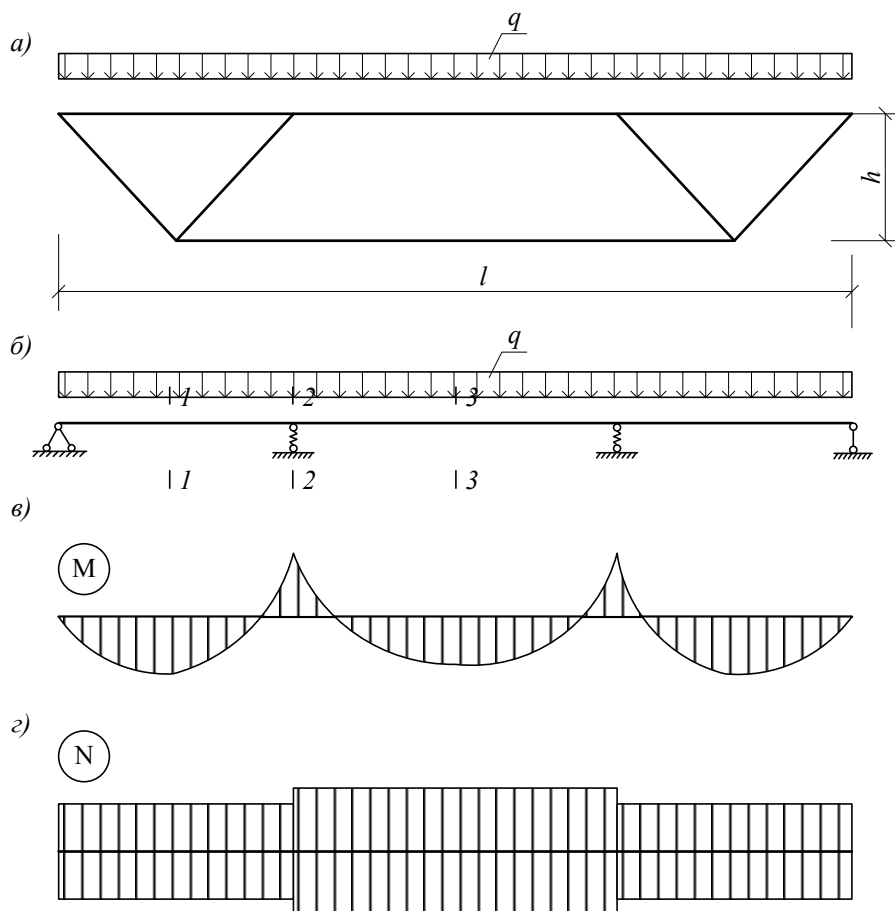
а – схема балко-ферми; б – розрахункова схема комбінованих конструкцій;
